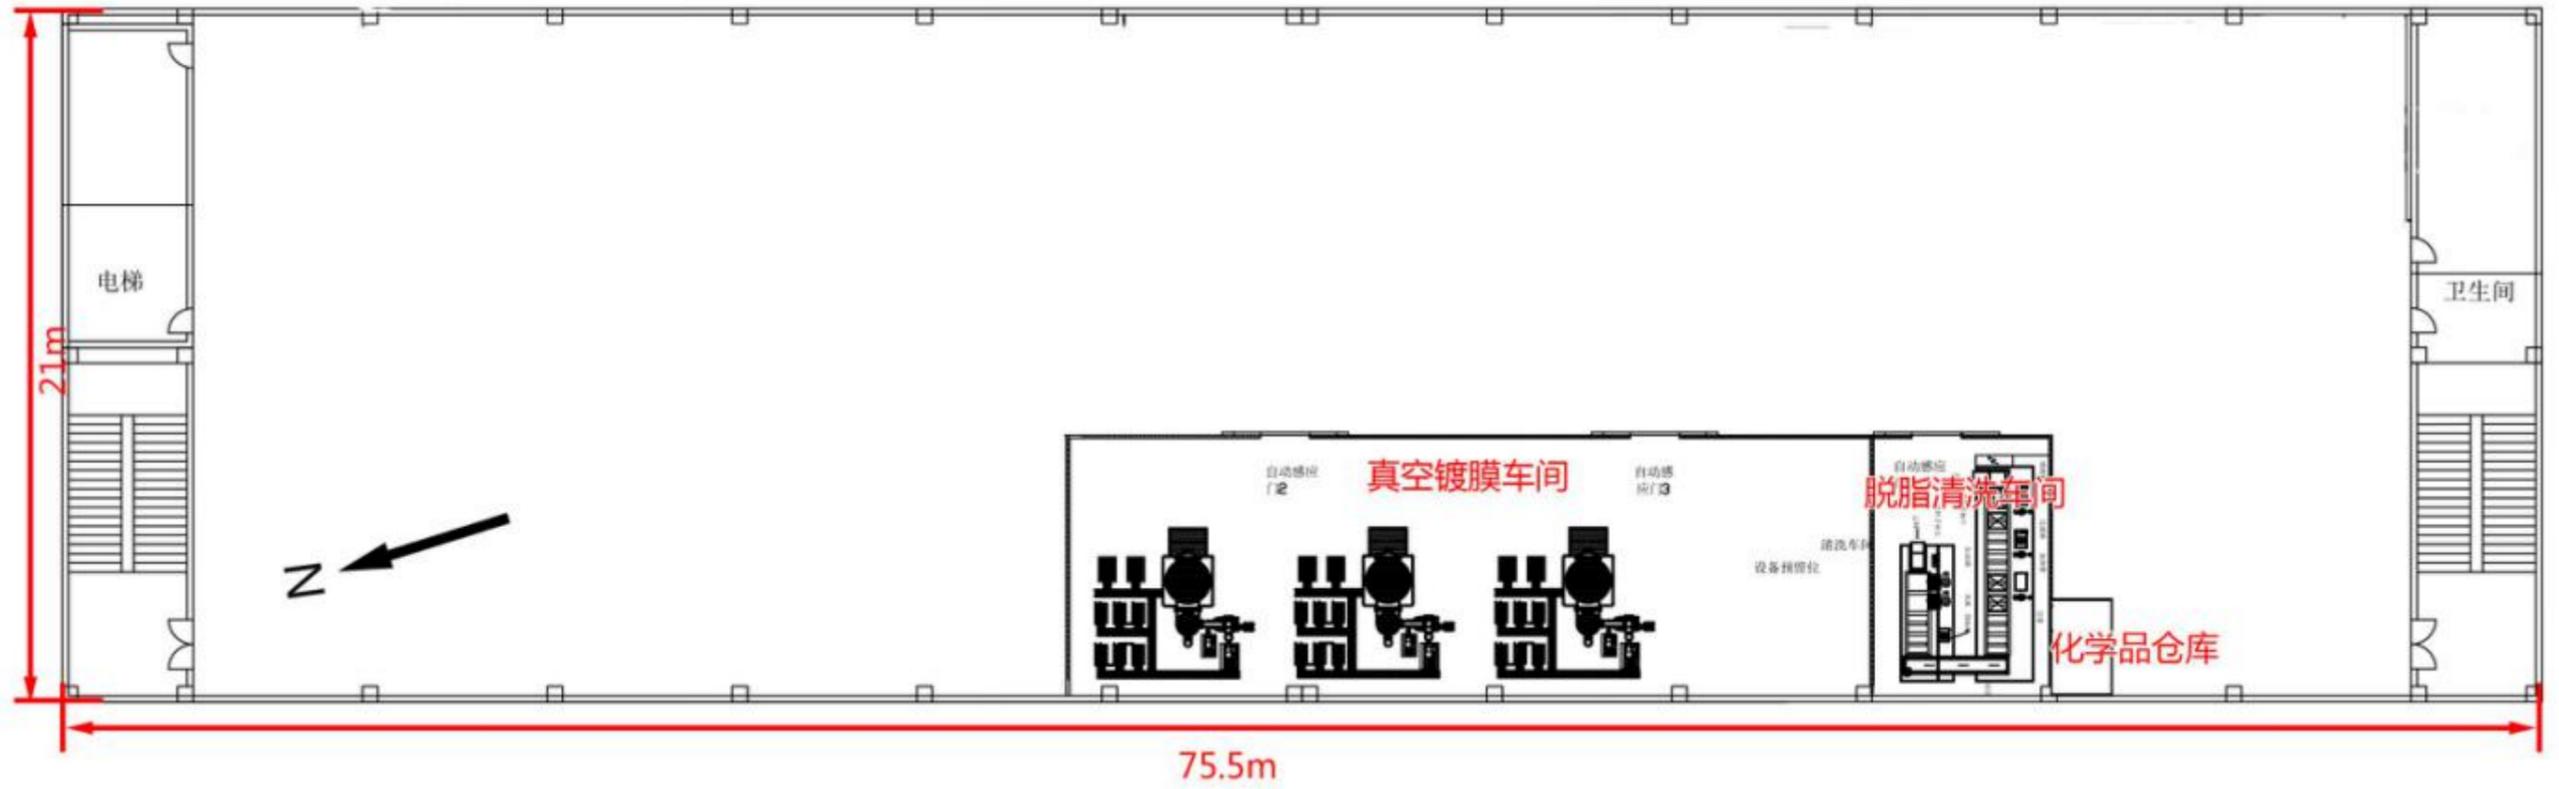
改扩建后真空镀膜车间平面布置图（A6 栋 2 楼）
